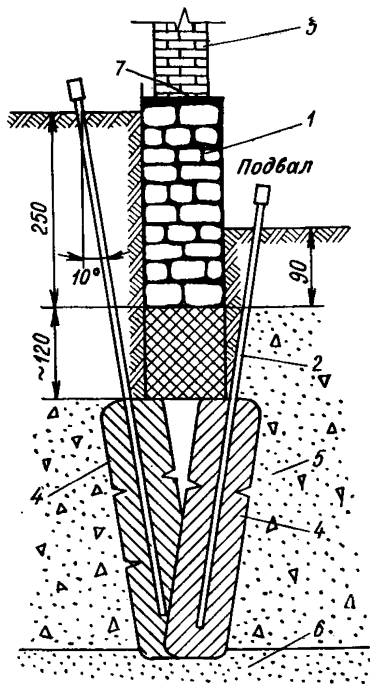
Разрез по закрепленному грунту под фундаментами 1 — старый бутовый фундамент; 2 — вновь подведенный фундамент; 3 — деформированная кирпичная стена; 4 — закрепленный силикатизацией массив грунта; 5 — толщина насыпного грунта мощностью около 5,0 м; 6 — разнозернистые пески; 7 — гидроизоляция
